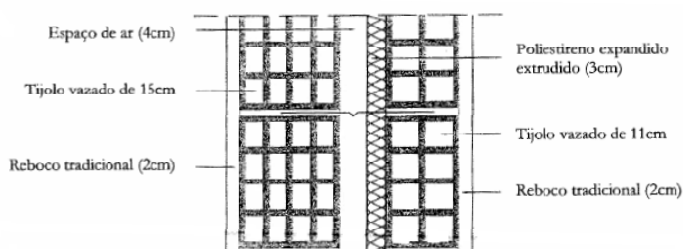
Parede dupla em alvenaria de tijolo vazado [14]
